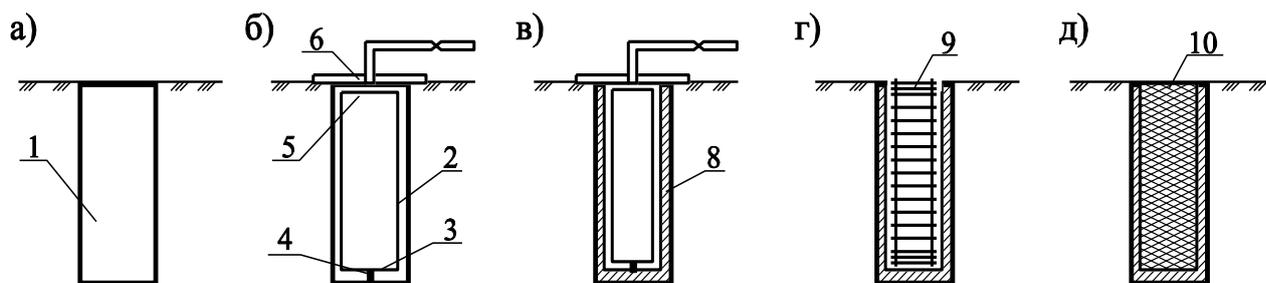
Способ устройства буронабивной сваи в засоленных грунтах ЗПГТ
